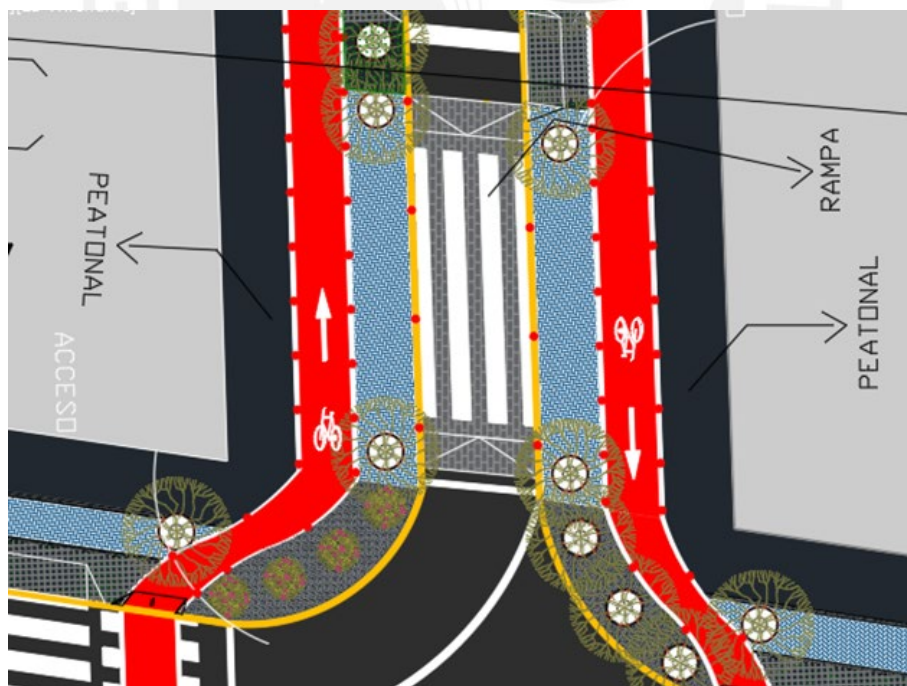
Diseño propuesto para la rampa de paso en la avenida arterial
